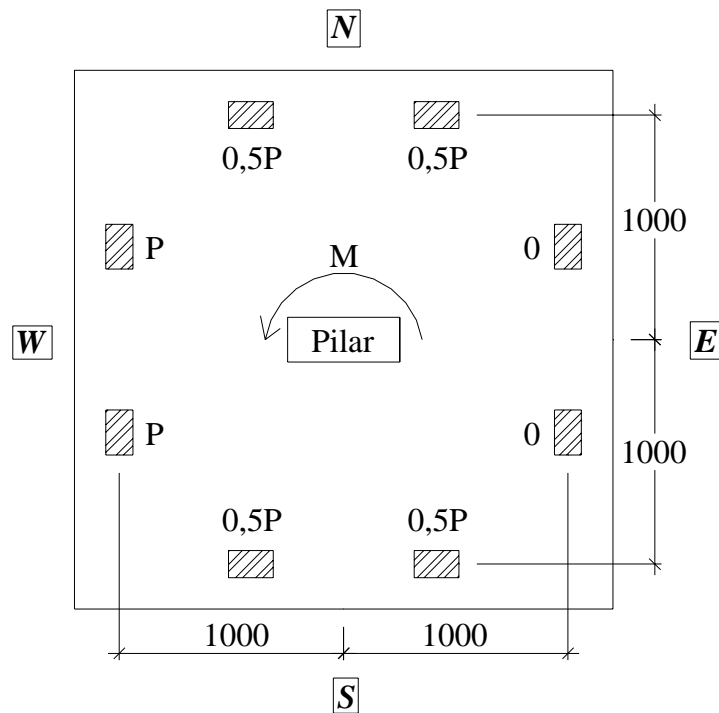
Carregamento da laje L11 (dimensões em mm)
